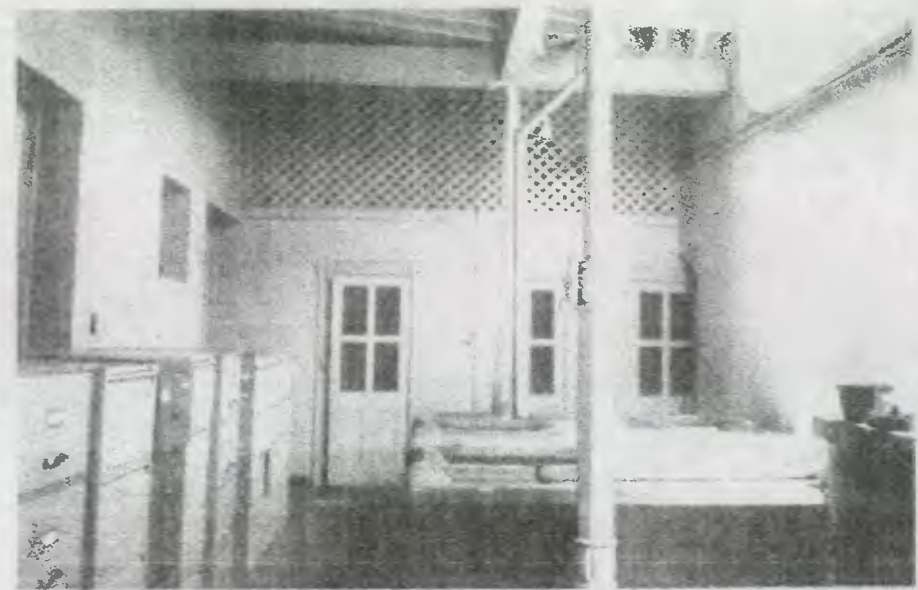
vista de lo que actualmente son un módulo de baños (al fondo) que han sido agregados.
